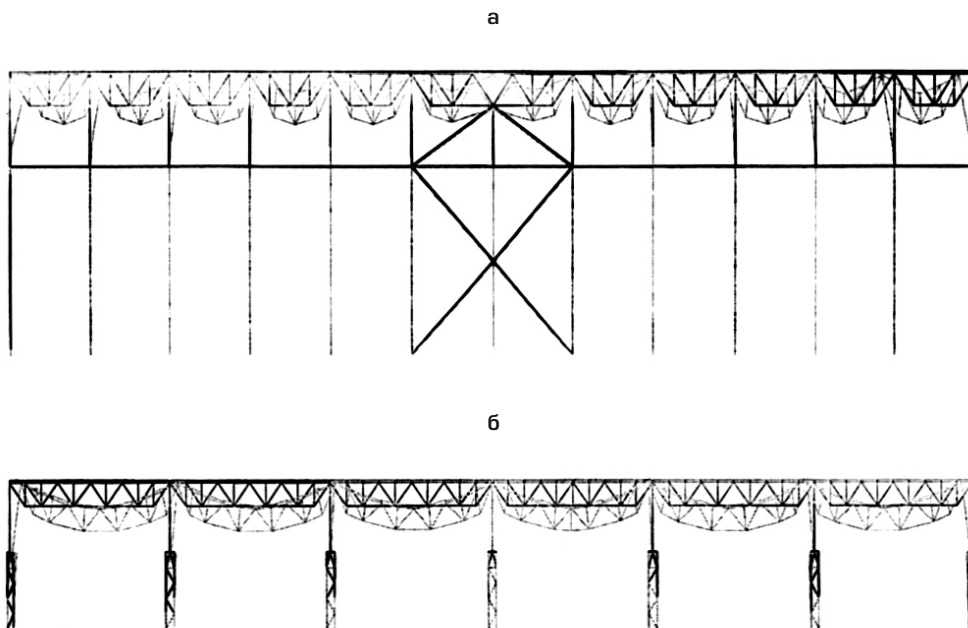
Деформация ряда подстропильных ферм с нисходящими опорными раскосами (а) и стропильных ферм с нисходящими опорными раскосами в поперечной раме каркаса (б)
